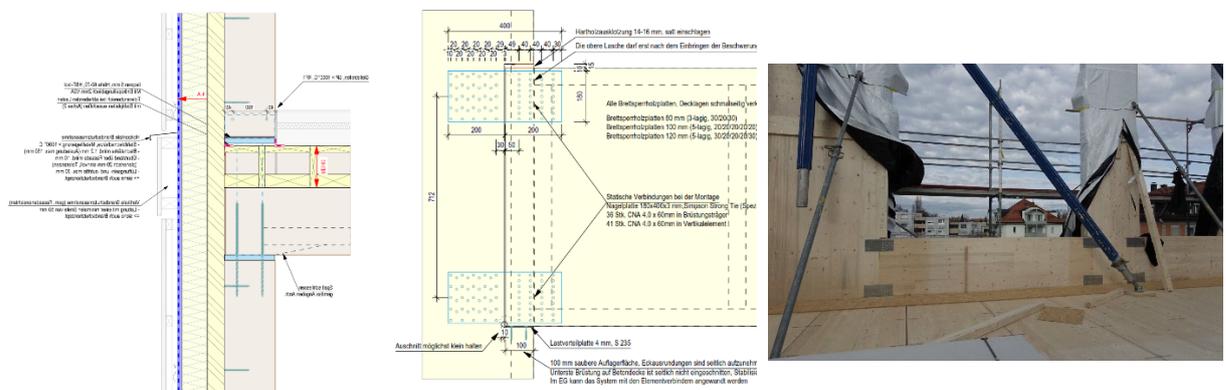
Aussenwandkonstruktion als Kombination von Holzrahmen- und Brettsperrholzbauweise (Vierendeelsystem)
